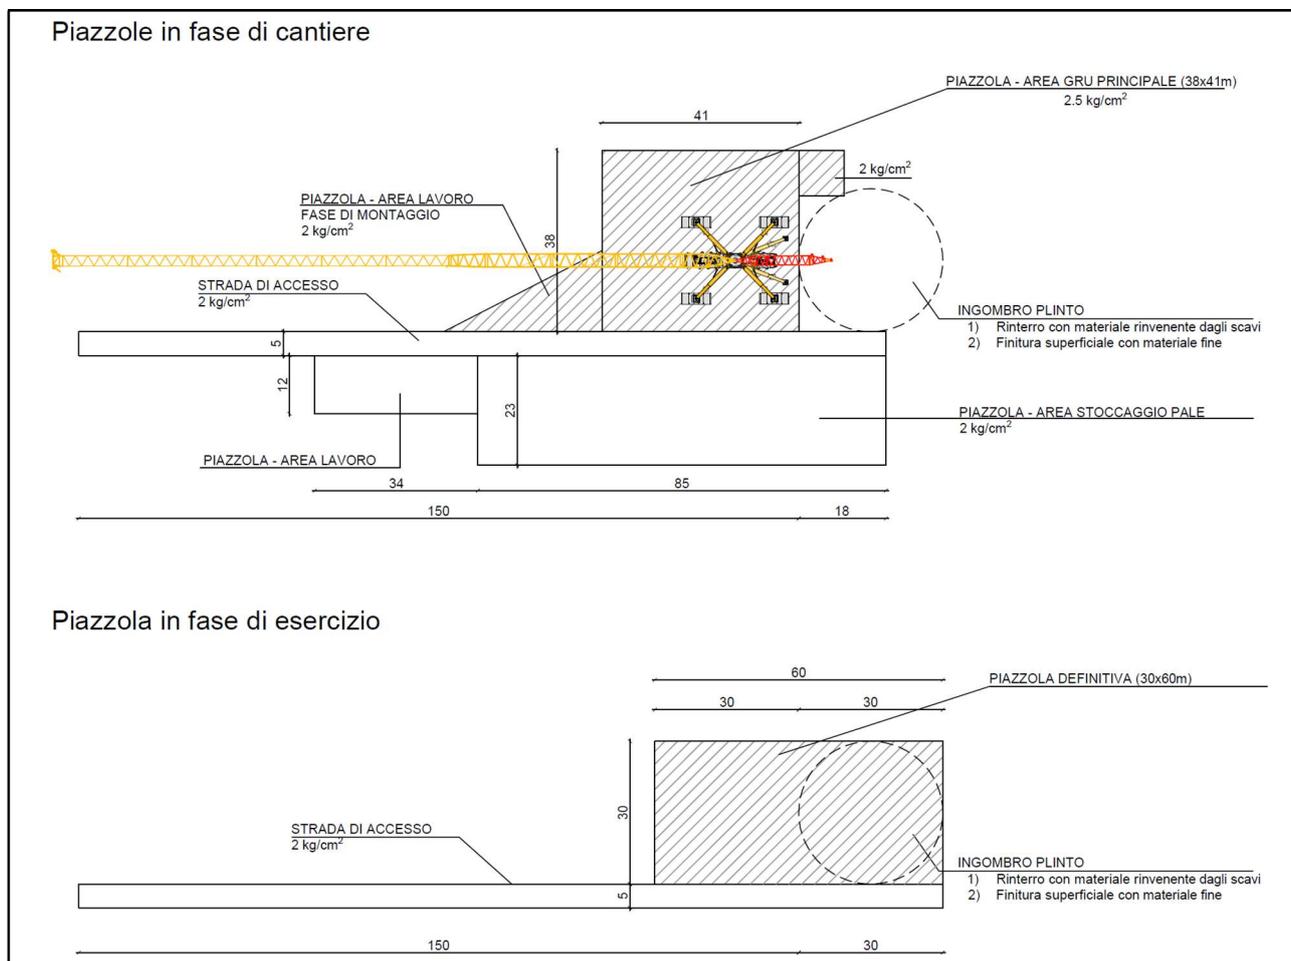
Planimetria piazzola tipo per la fase di installazione e fase di esercizio e manutenzione
